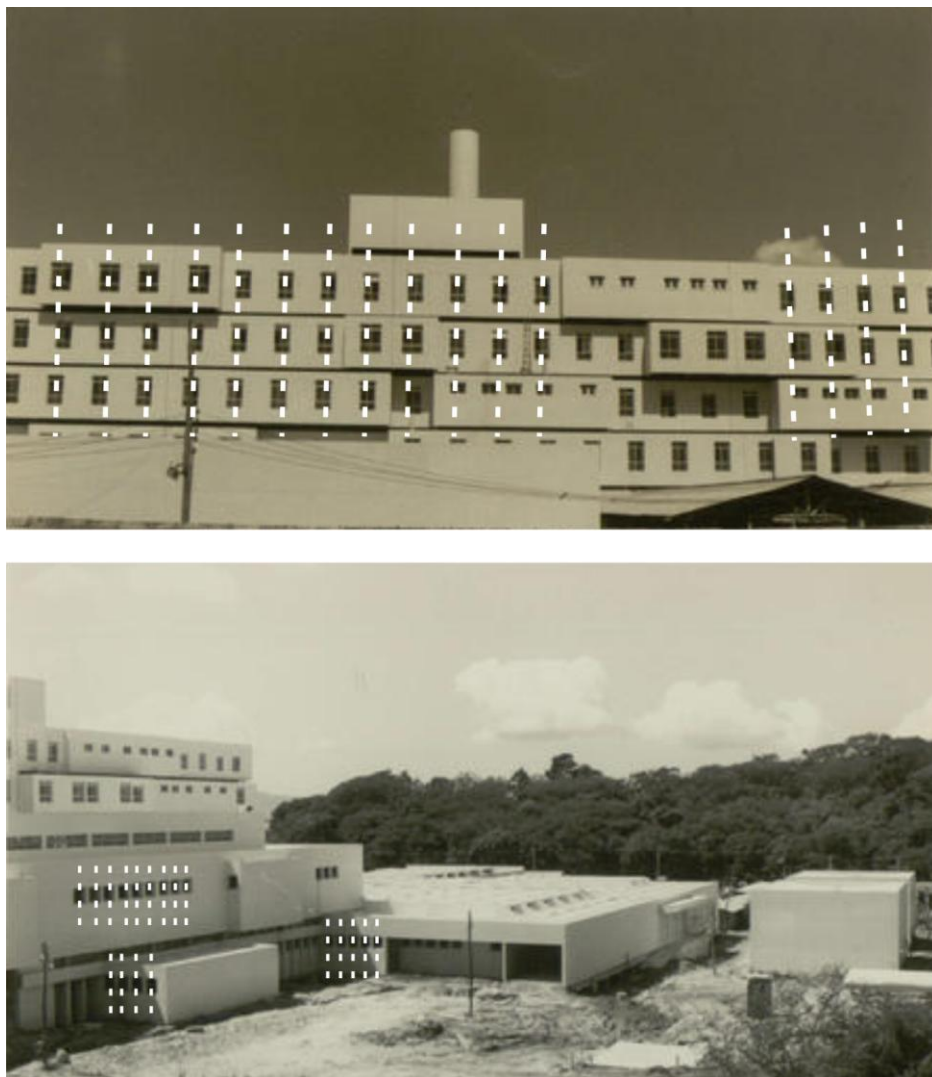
Demarcação de disposição e ritmo imposto em fachada pelas aberturas
